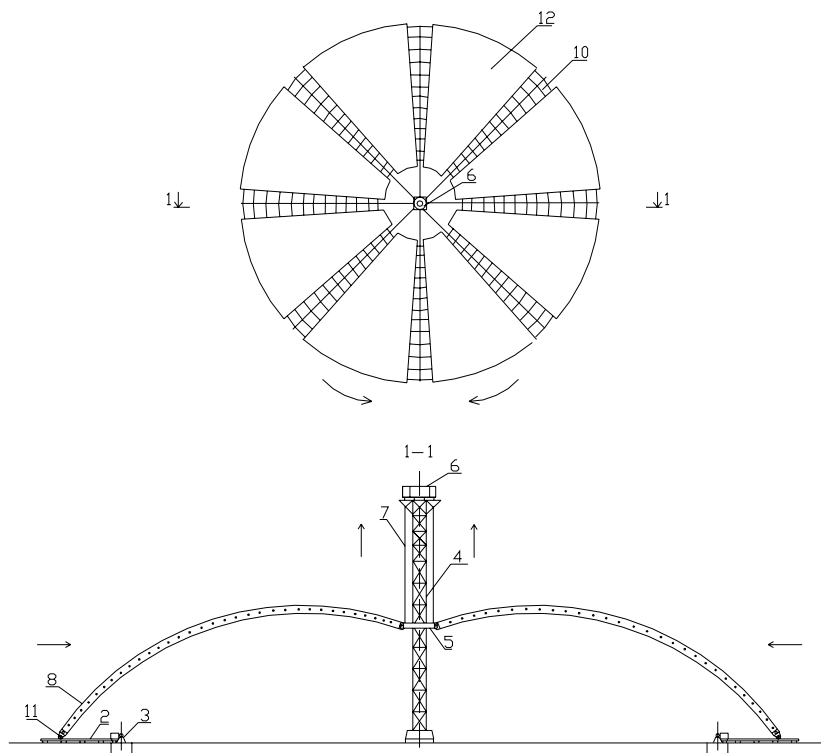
Опалубка при подъеме: 2 – роликовые пути; 3 – опорный шарнир; 4 – временная опора; 5 – подъемное кольцо; 6 – лебедка; 7 – тросы; 8 – кружала; 10 – арматура; 11 – ролик; 12 – палуба опалубки.
